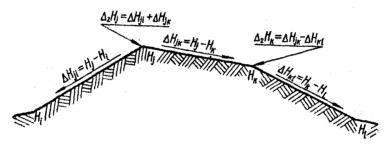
Расчетная схема проектирования вертикальной планировки методом числовых отметок
